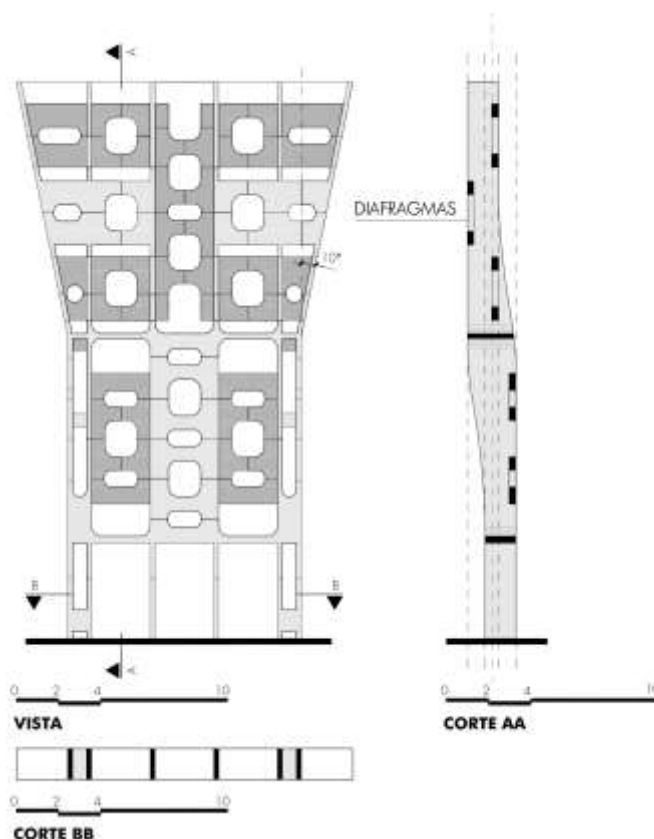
Corte transversal demonstrando os sistemas e elementos estruturais.
